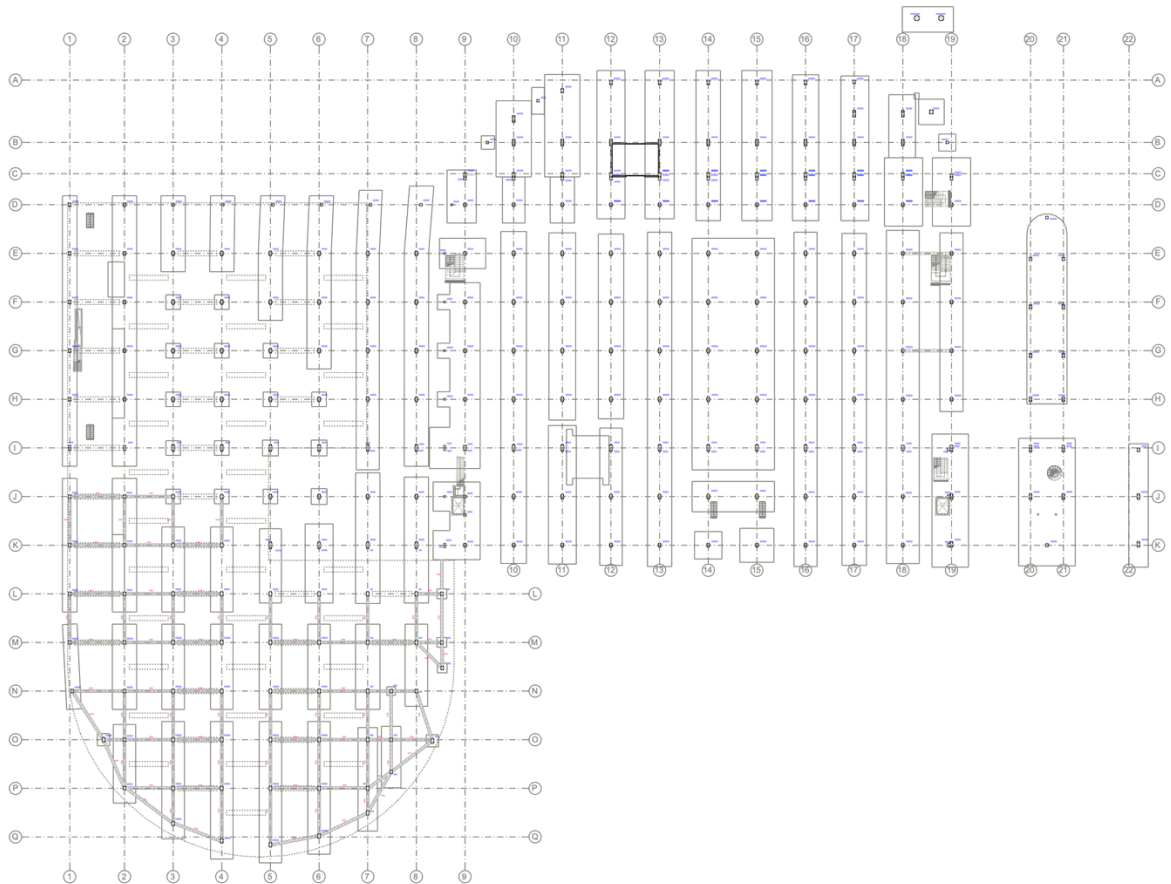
Planta de Cimentación. Elaborada con ArchiCAD 23. Fuente: Elaboración propia.
